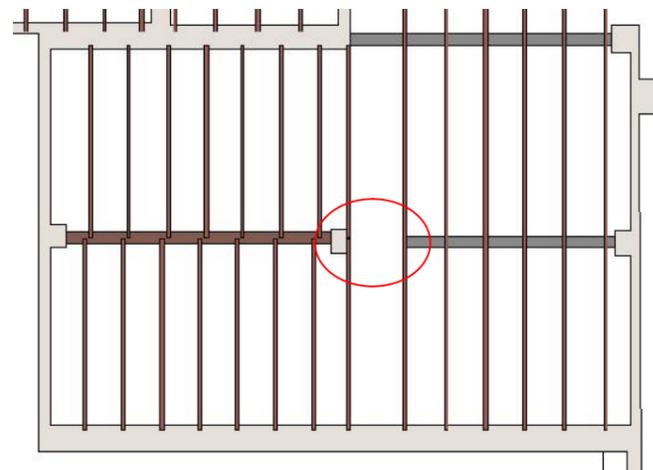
Vista en planta de la estructura modificada. Fuente: propia autora
